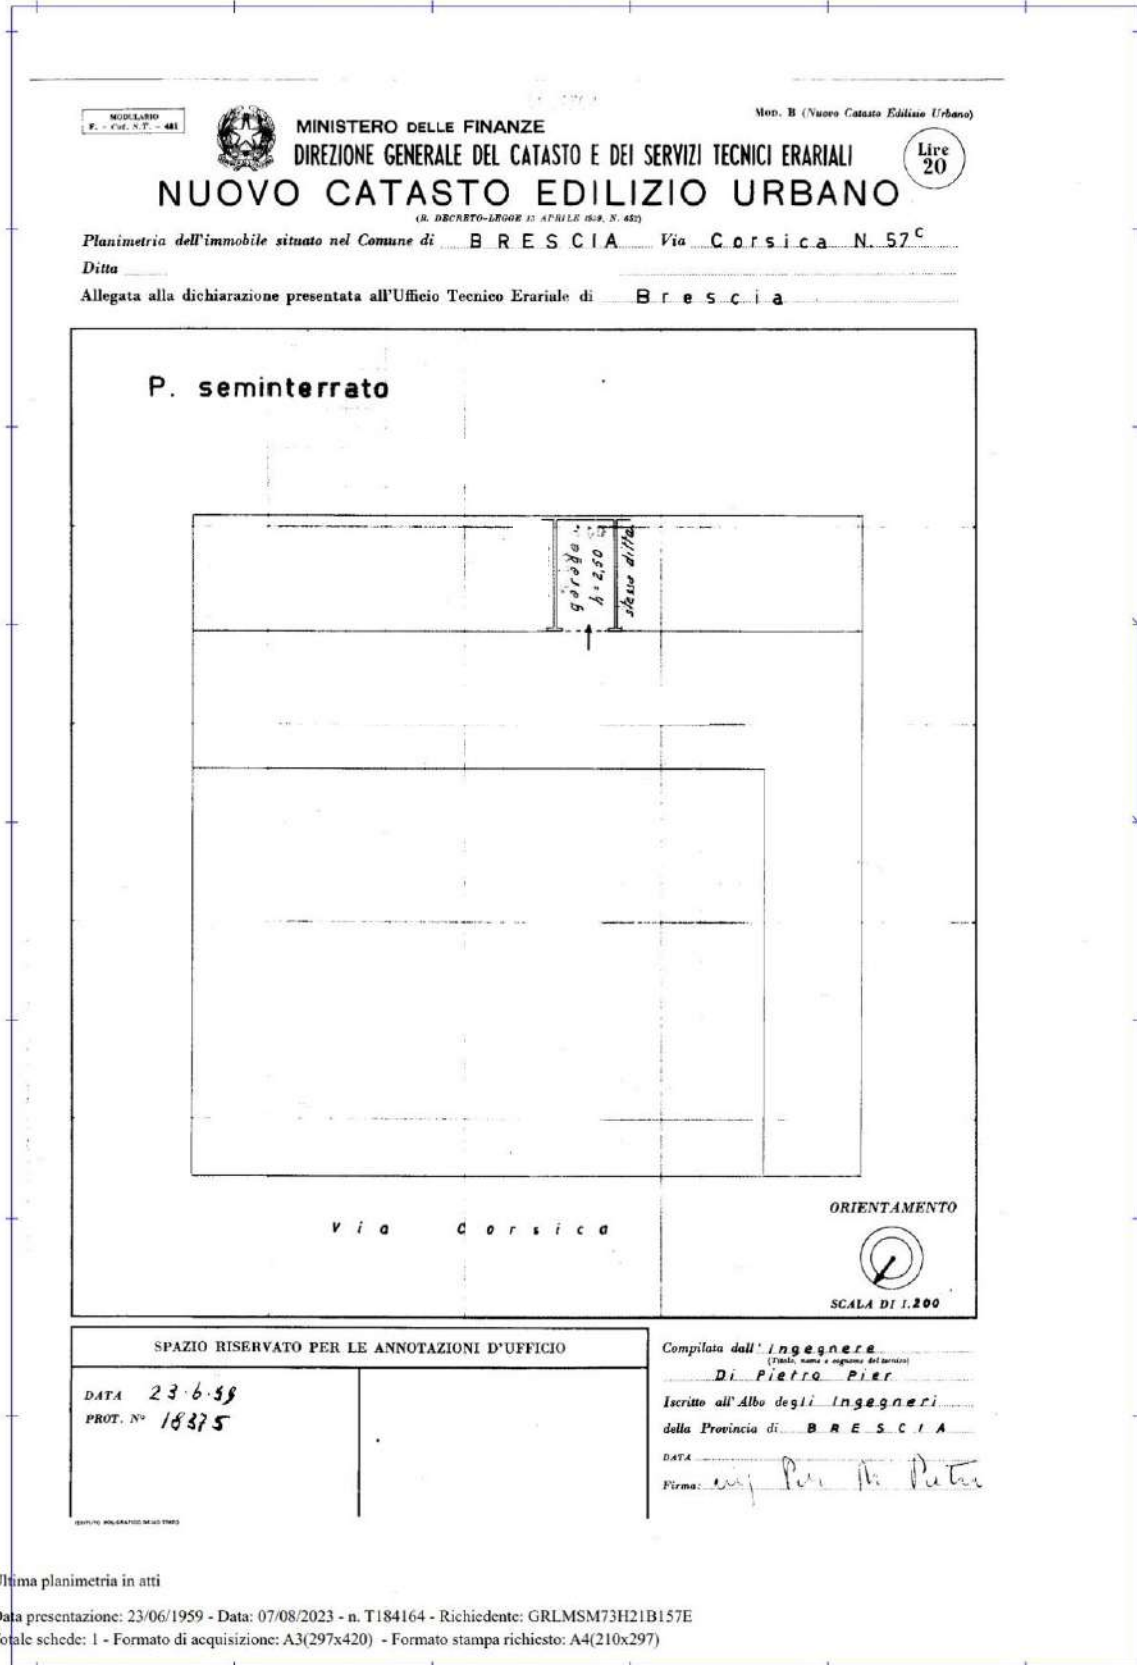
Estratto planimetria – Sez. SNA fg.6 Part. 4095 sub 4
